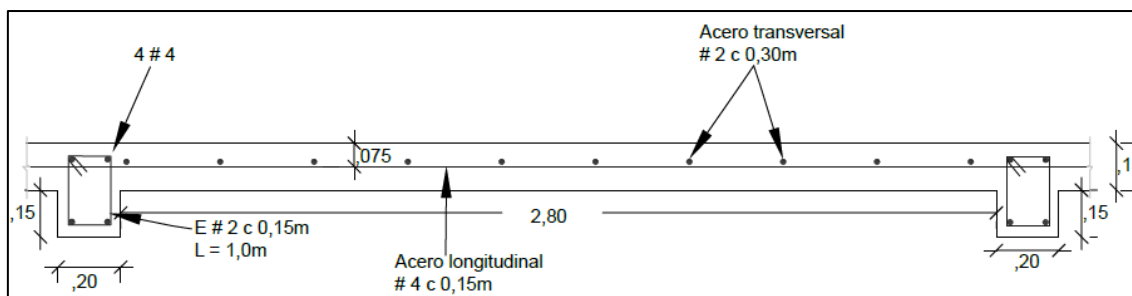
Corte longitudinal con detalles de refuerzo [3]
